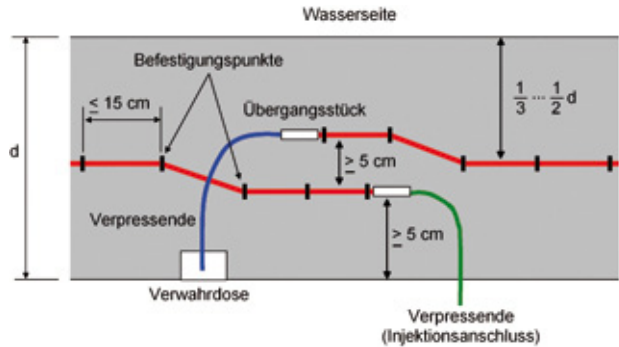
Abstände beim Einbau von Injektionsschlauchsystemen
